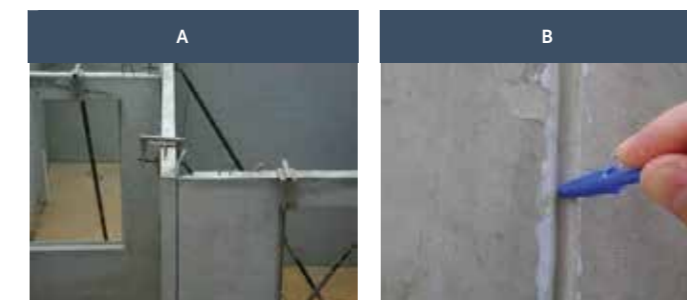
| Painéis pré-fabricados com nervuras de concreto e preenchimento de blocos cerâmicos
